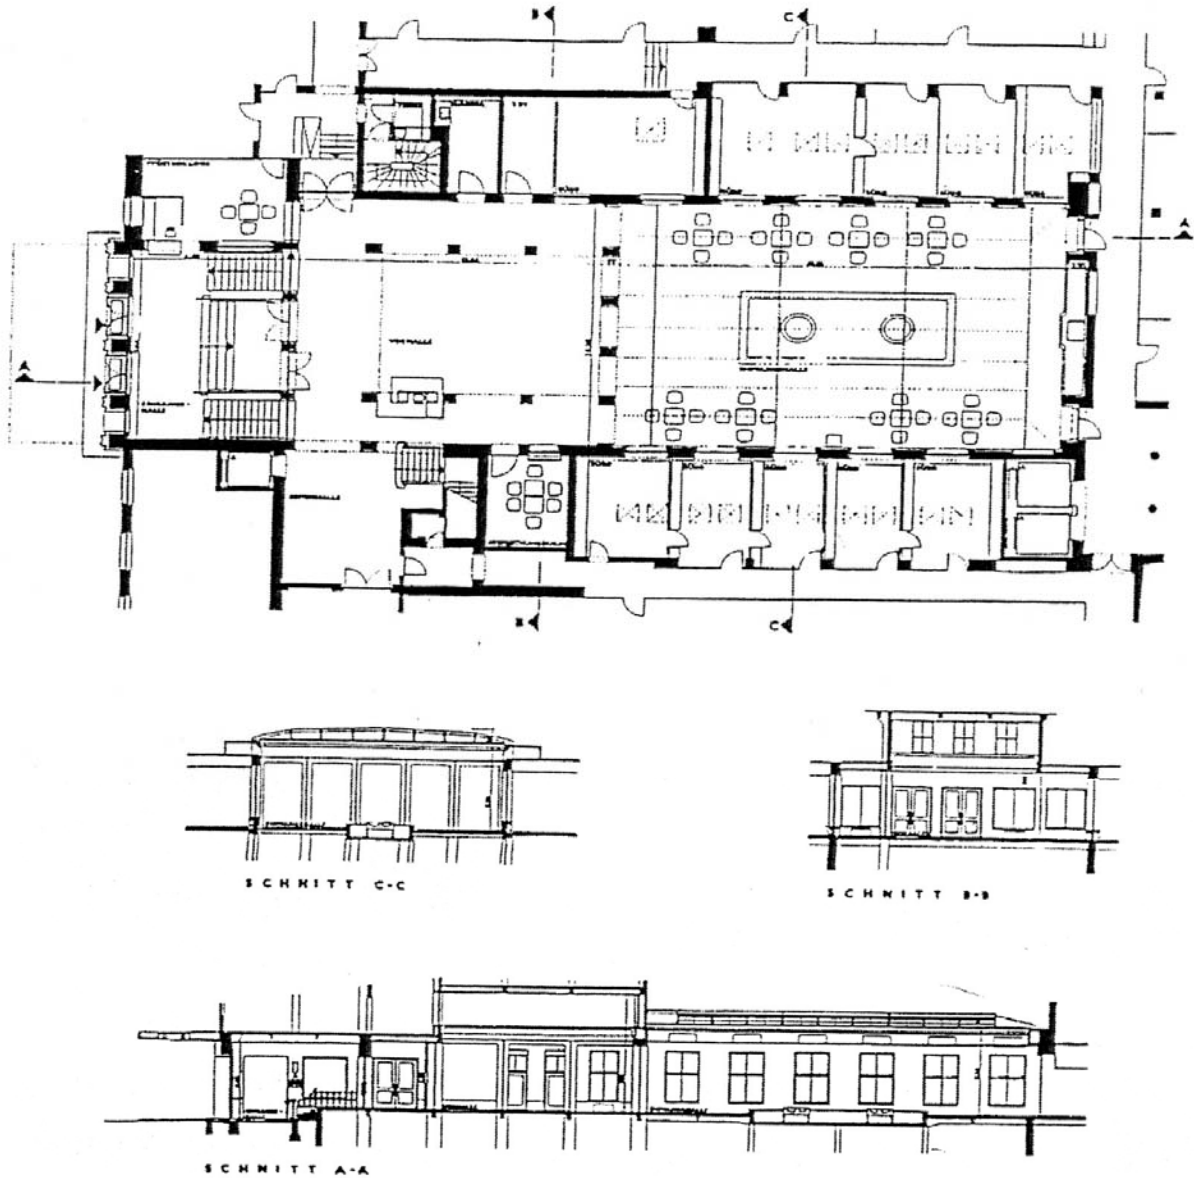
Turmbau – Eingangs-, Vor- und Empfangshalle (von links nach rechts), Grundriss- und Schnittzeichnung des Erdgeschosses aus 1976, Bau aus 1927/ 28 – Architekt: Walter Furthmann
